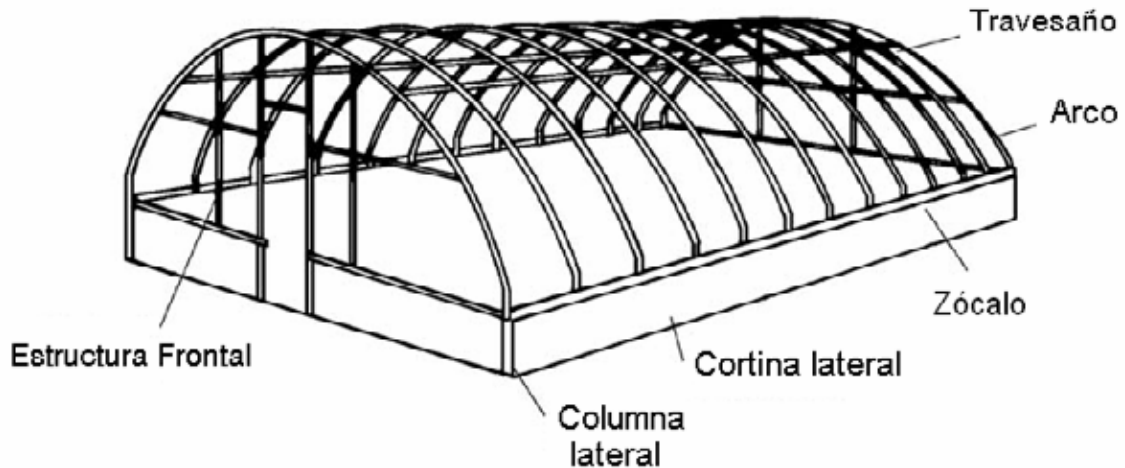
El armazón de las estructuras de propagación soportan la cubierta, y los dos tipos básicos son los de puntales y el tipo túnel (modificado de Nelson 1991, Hummert, 1993).
